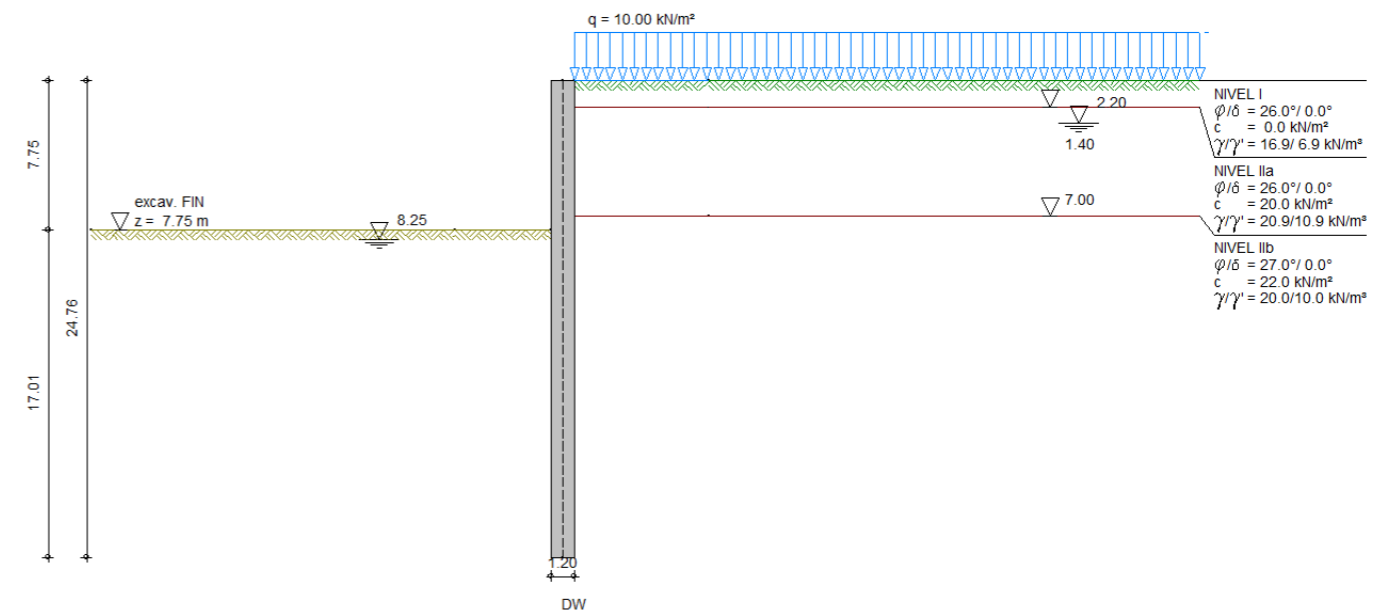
Sección muro pantalla en ménsula. Fuente: DC-Pit y elaboración propia
